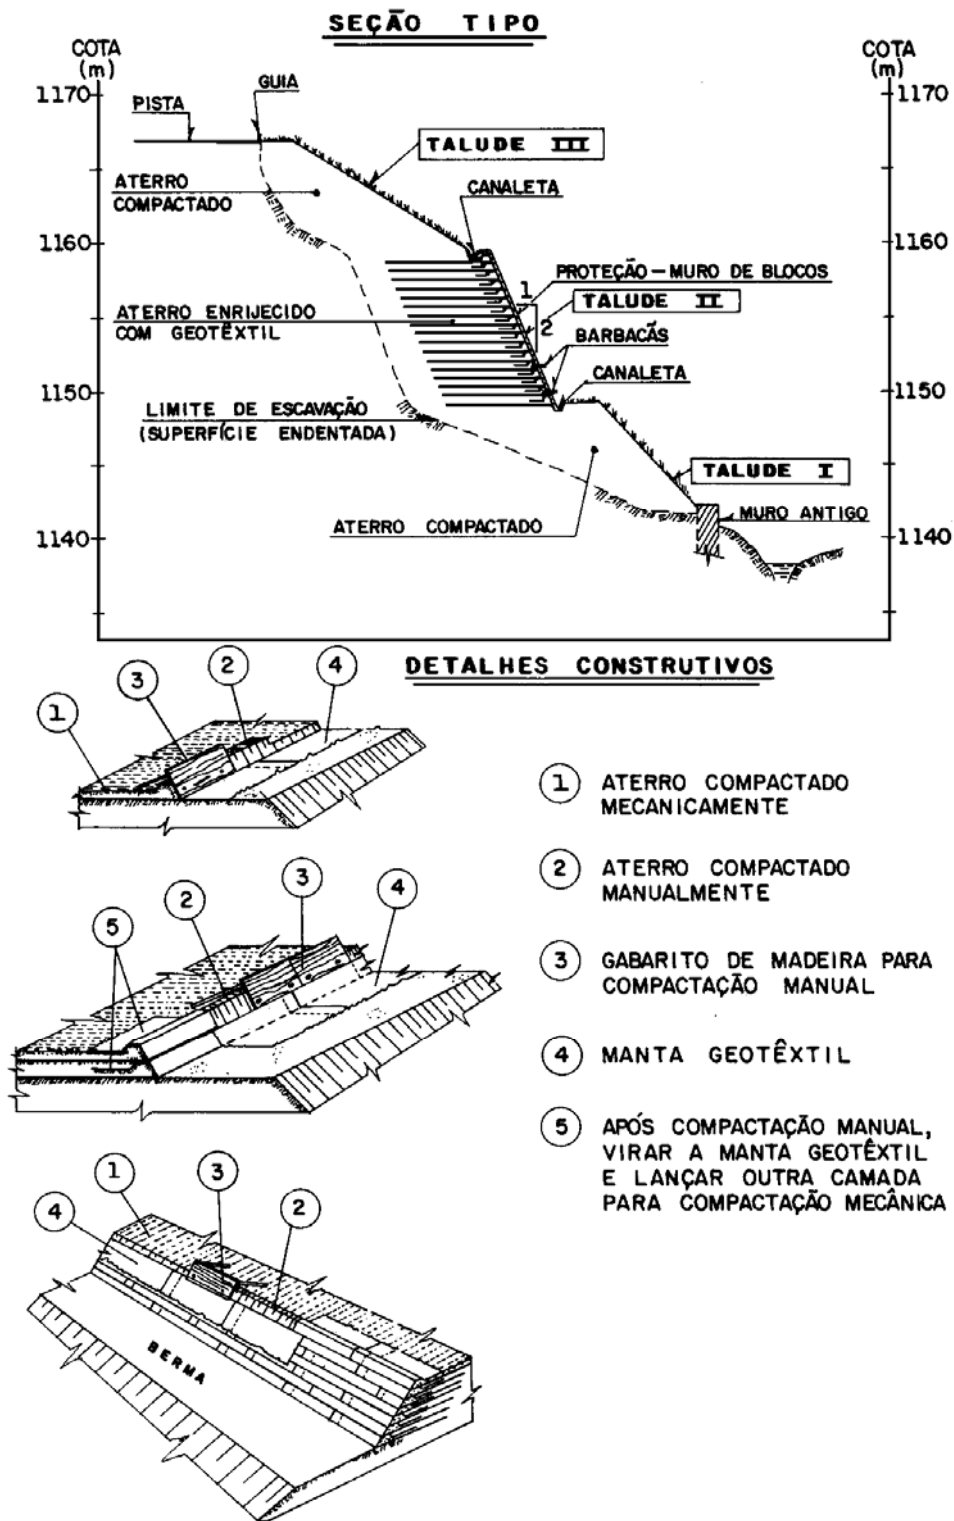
Seção tipo e detalhes construtivos do aterro reforçado com geotêxteis da SP-123
